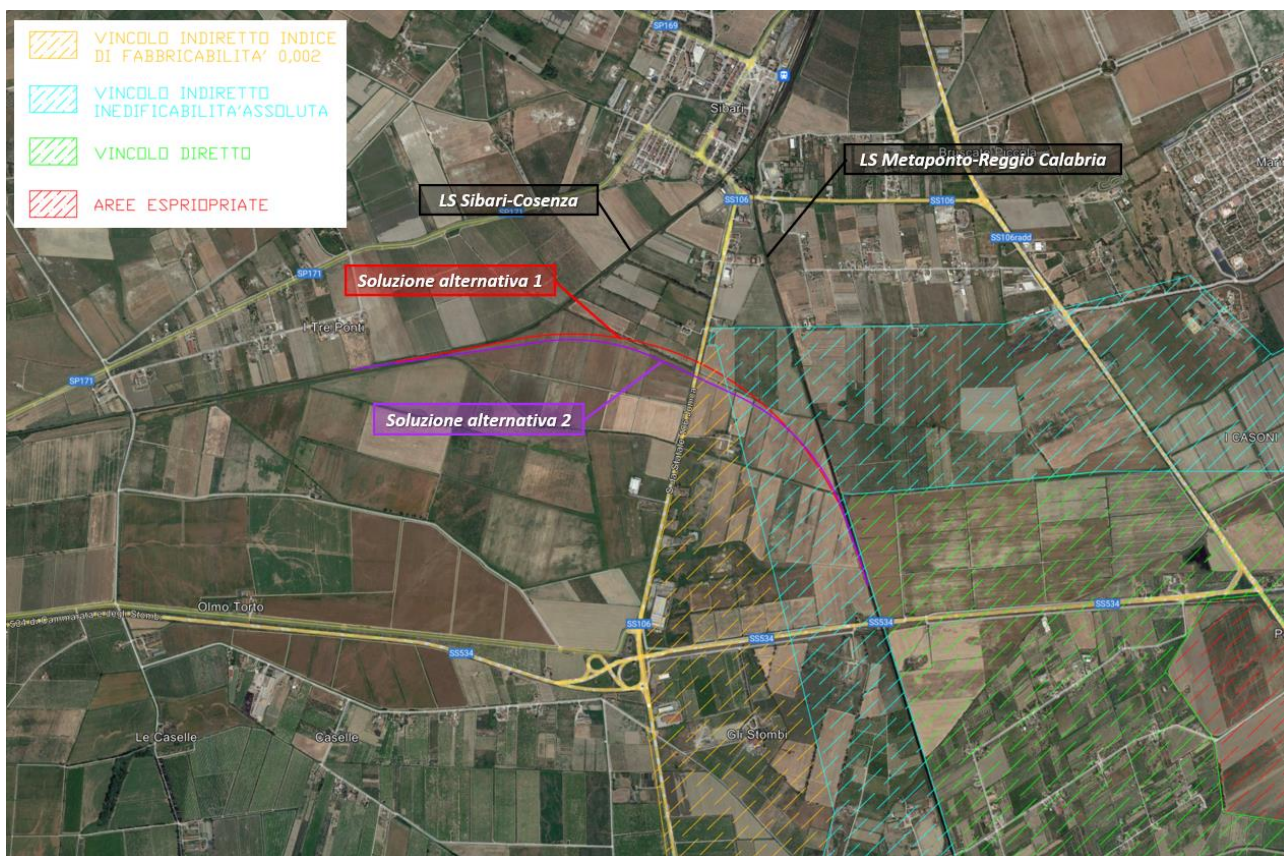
Stralcio planimetrico con individuazione vincolo archeologico
